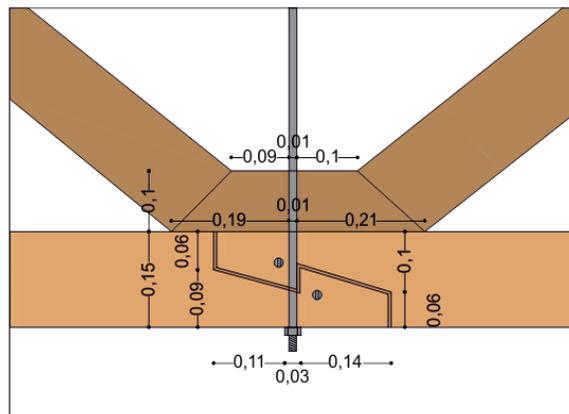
Detalle A, detalle estructura de cubierta, Estación del ferrocarril Sur.
